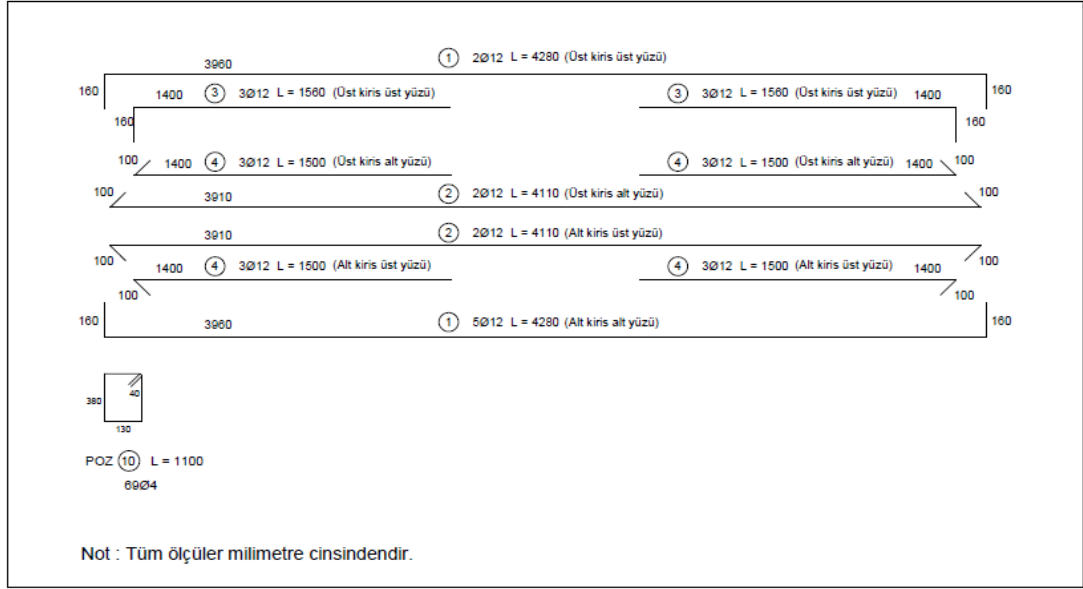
RBN Kirişi kiriş donatı Planı ve Kesitleri
